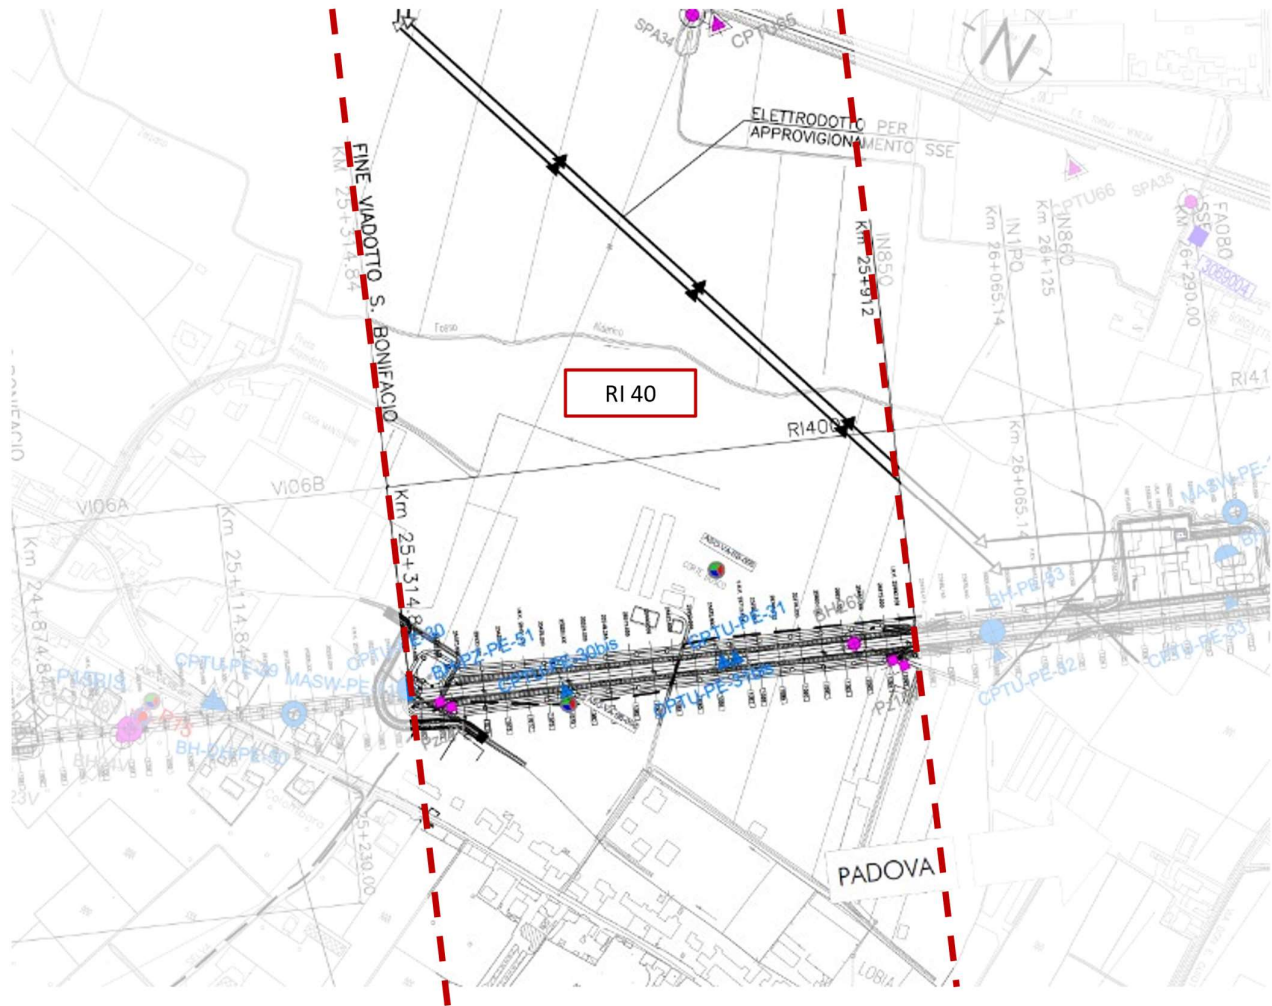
Planimetria Rilevato RI40, estratto dalla Planimetria Generale (Doc. Rif. [3])
